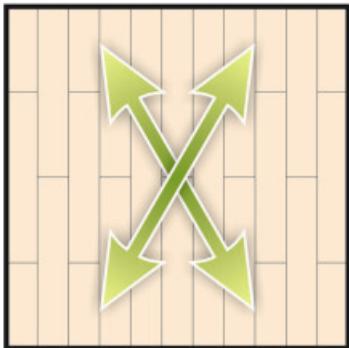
Brusný sled u starých, silně ušpiněných parket – renovace.
